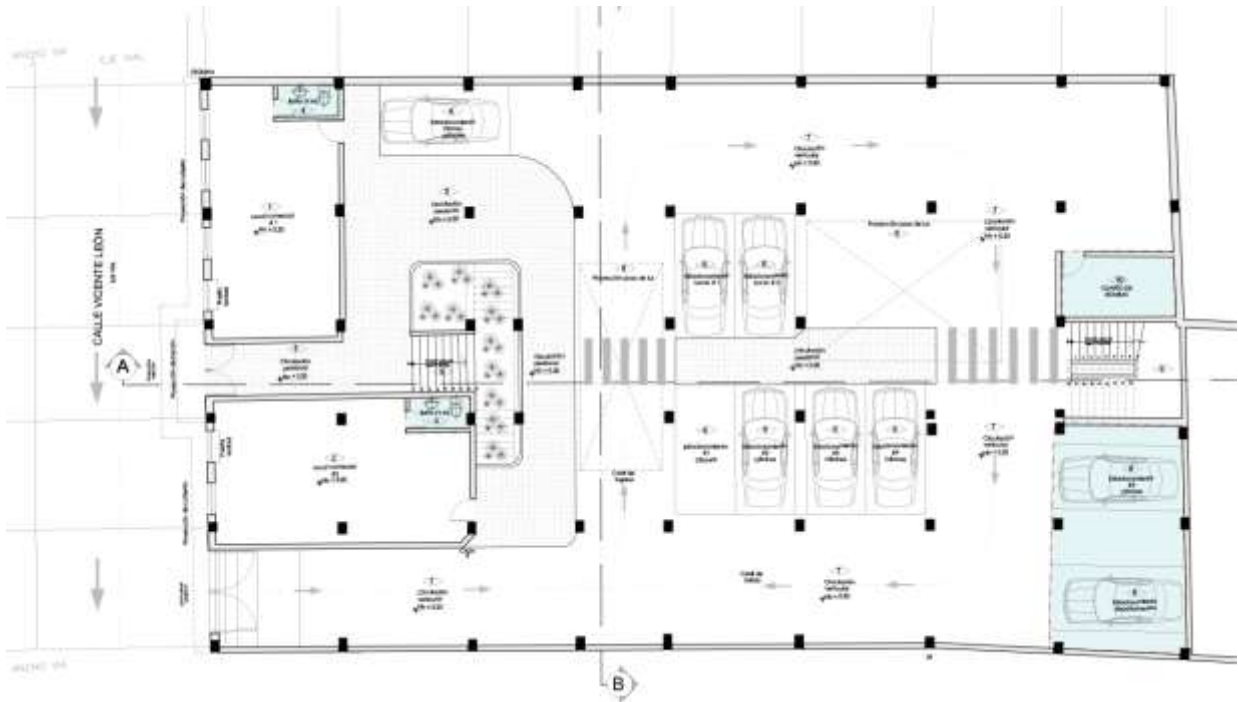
Planta baja estado actual, se marca los elementos a intervenir
